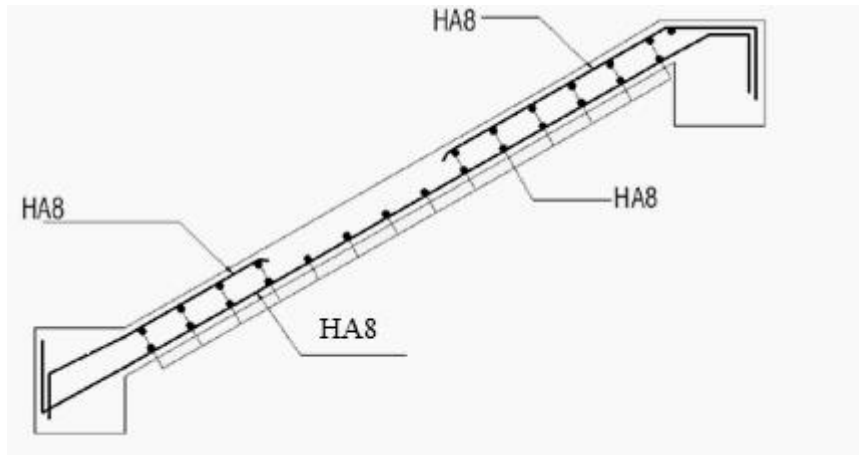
Schéma de ferrailage de l'escalier type2 (volée2)
